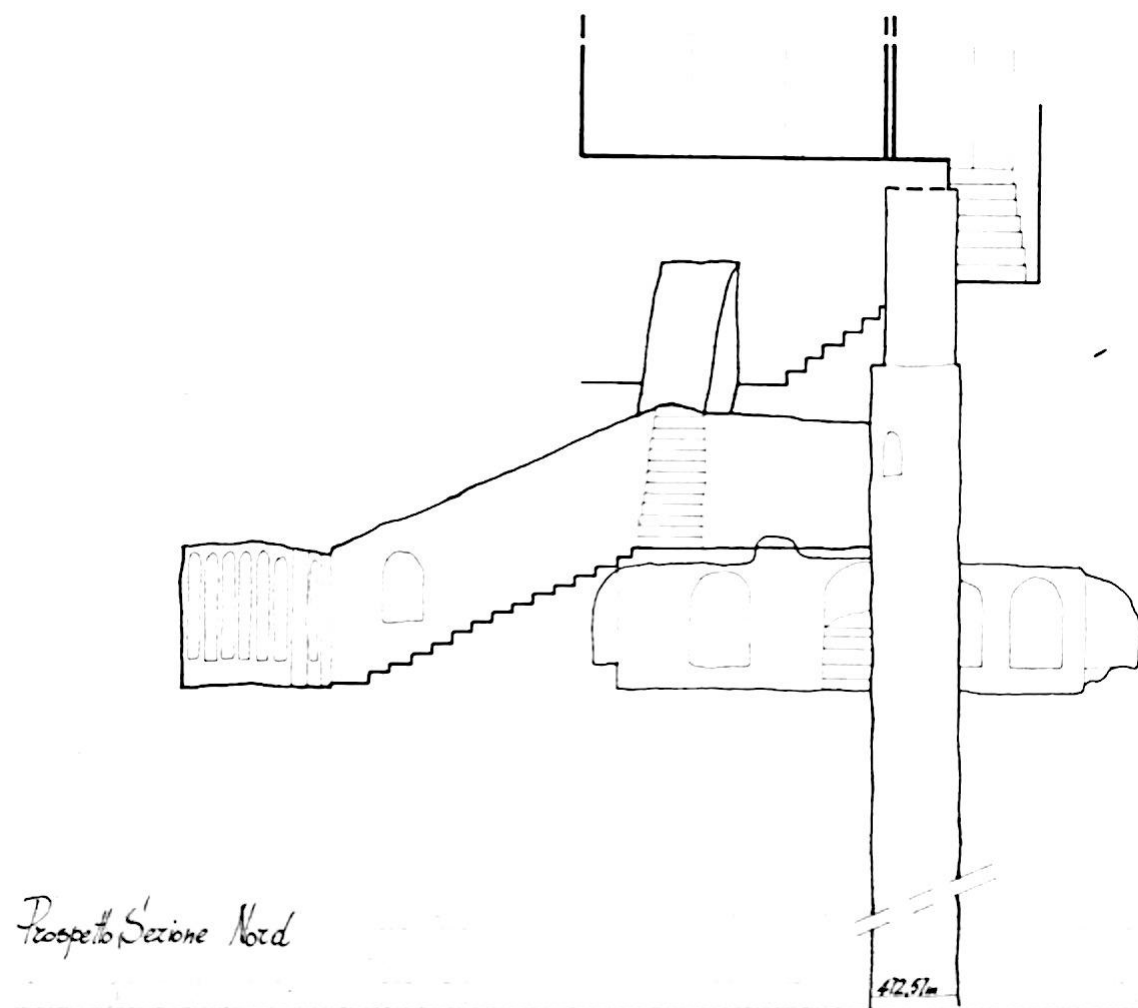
Appunti del rilevamento del cunicolo n. 8 (Casa Mori, abitazione privata). Prospetto della sezione nord.
